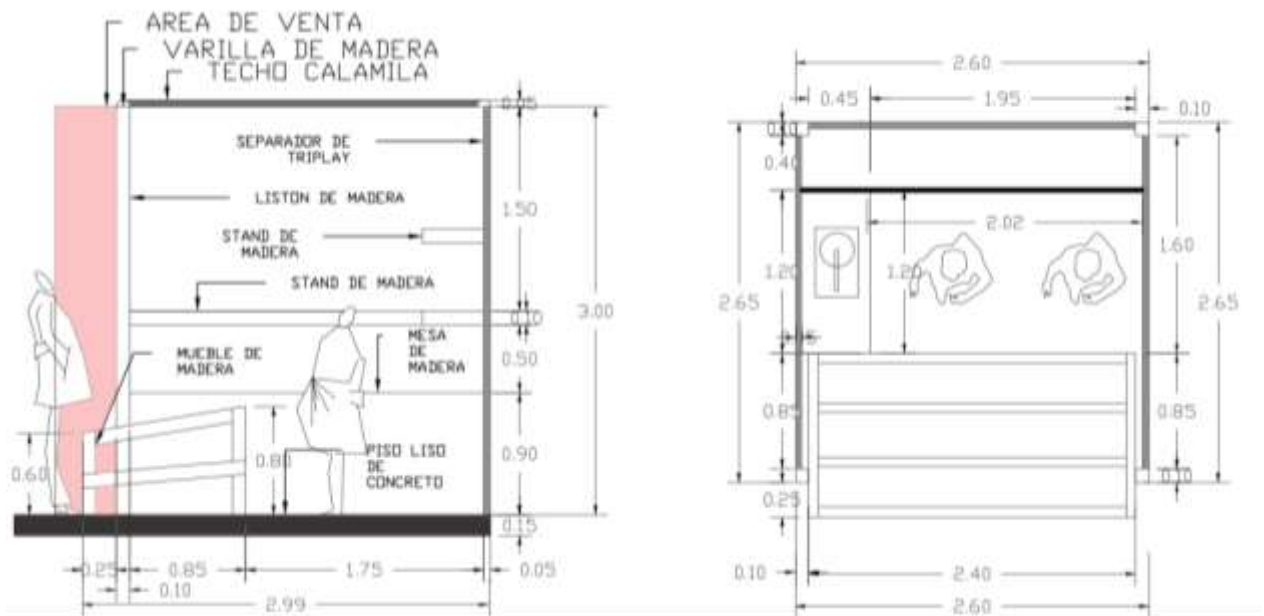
Corte detallado y Planta del G. Verduras / Elaboración propia
